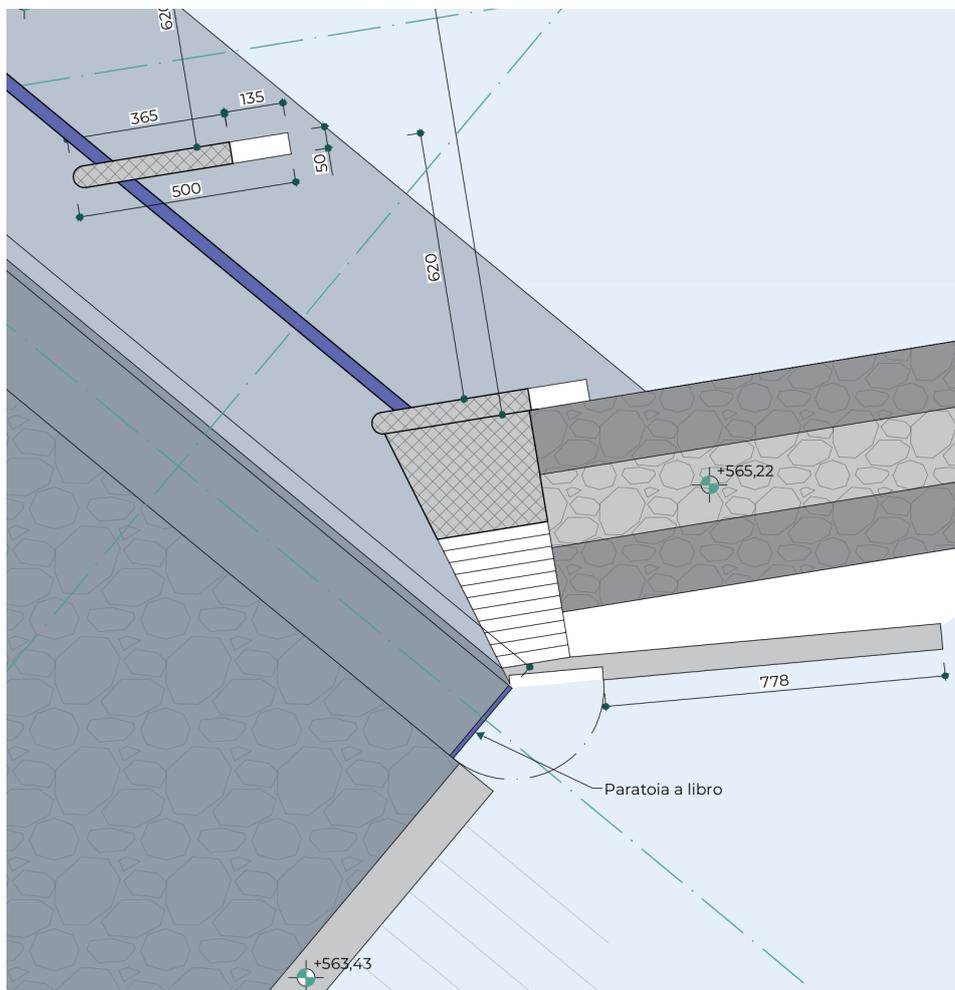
Dettaglio della planimetria di imbocco canale Paravera con in primo piano la paratoia a libro.
